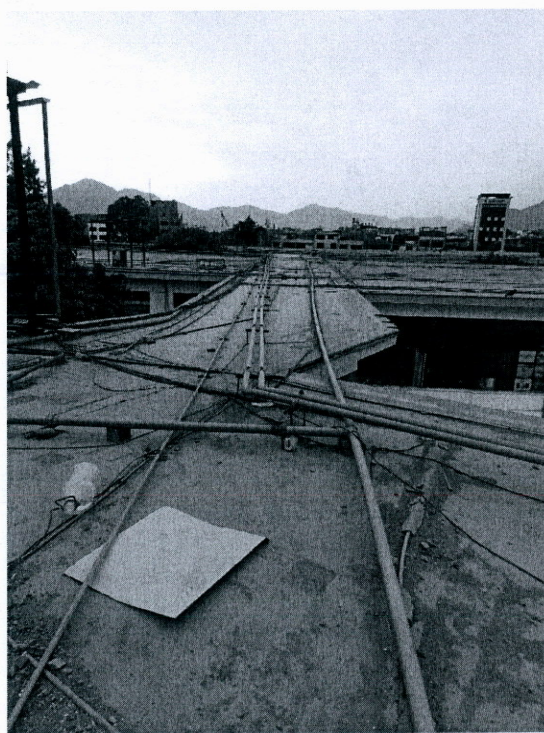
Azotea: Se observa la corrosión de las válvulas de sectorización y tubería de PVC no cuenta con soportería y no tiene un orden de instalación.
